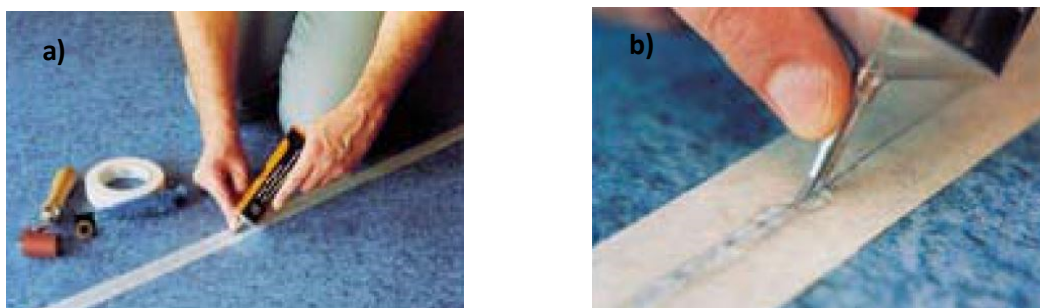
a) Manuseamento do bisnaga na soldagem a frio [31] ; b) pormenor do refluimento da cola [31].
